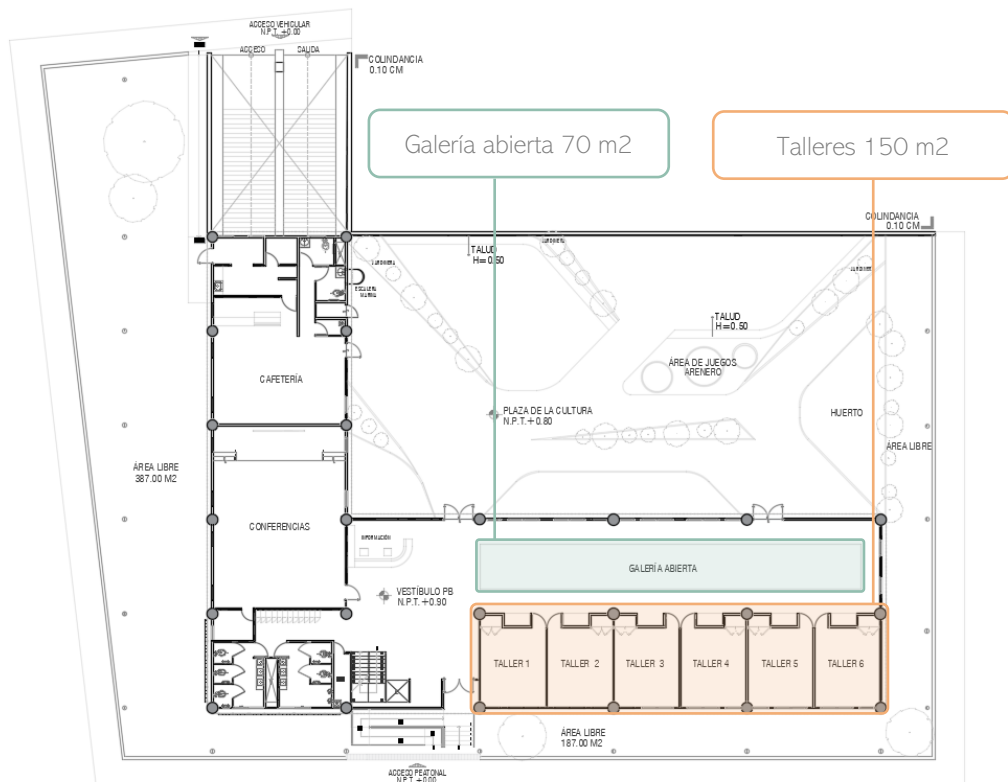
Valdespino T. (2020) Planta baja, A-02. *Galería abierta y talleres* [Plano] esc.: 1:250,000. Biblioteca Pública Municipal Ecatepec de Morelos, Estado de México [Tesis de Licenciatura]. Facultad de Arquitectura UNAM.
